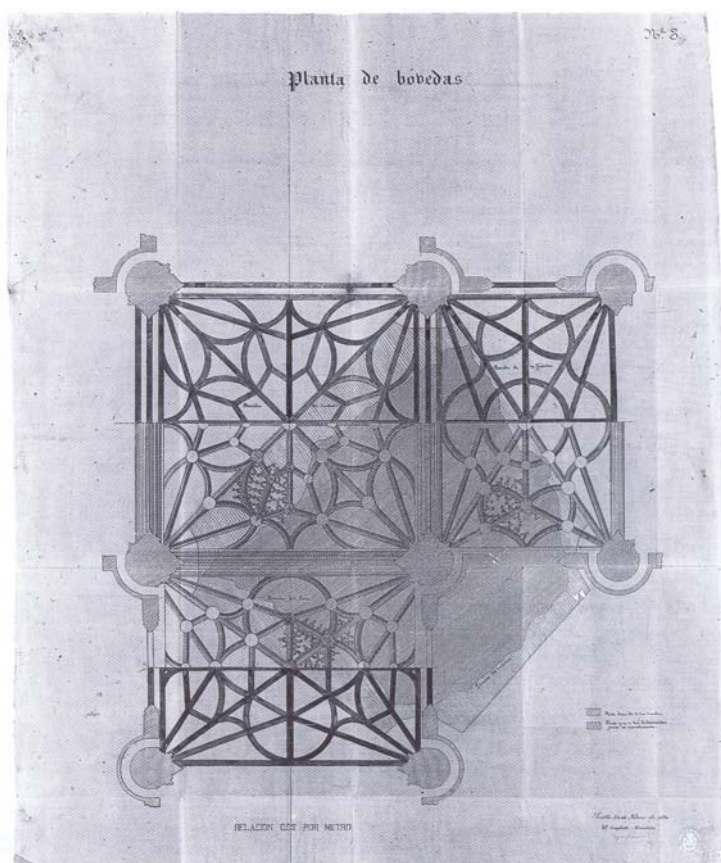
Planta de bóvedas de Joaquín Fernández Ayarragaray. 1890.
